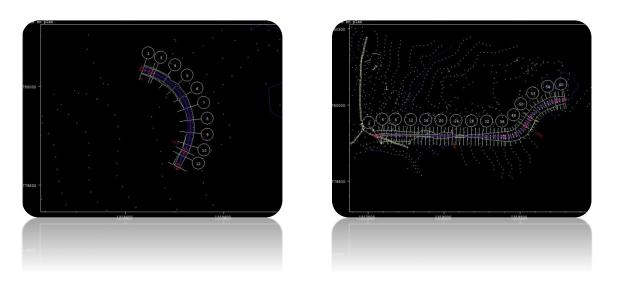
c : Tracé en plan de Boucle. Figure VI-21-d : Tracé en plan de Brettelle.
